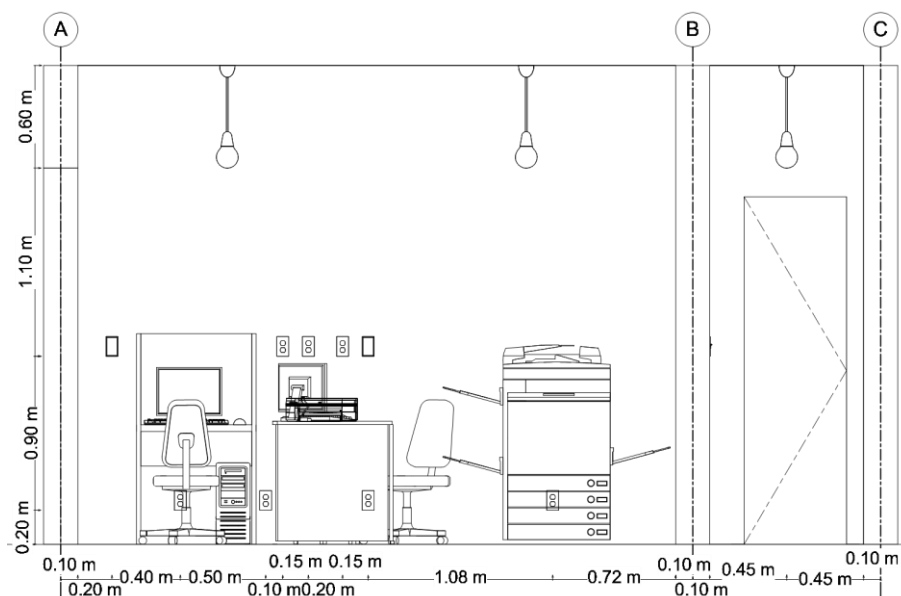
Plano de corte, área del encargado, ubicación de los contactos y apagadores.
